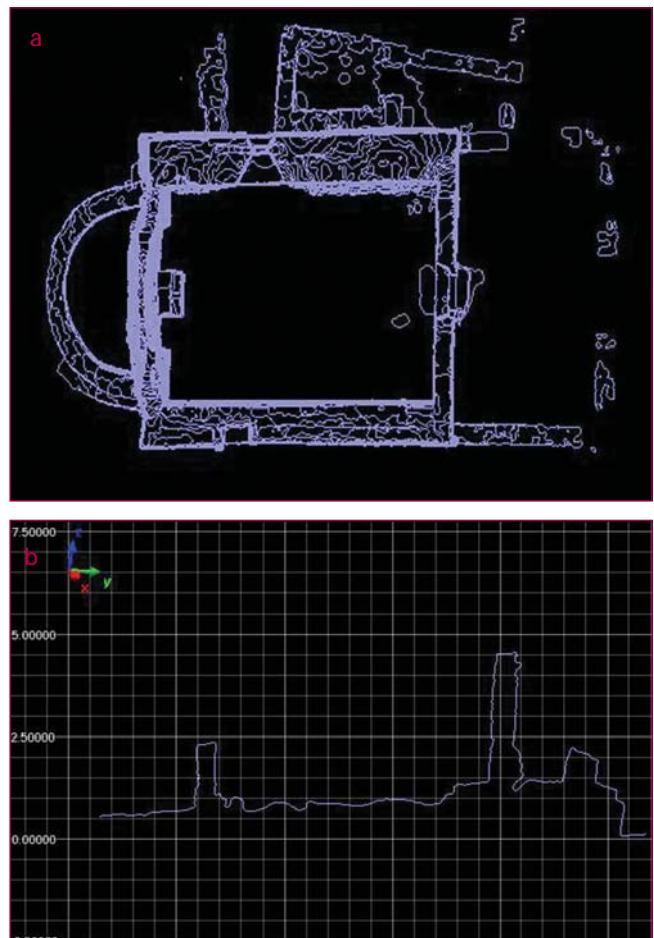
Sezioni e profili ricavati direttamente dal modello 3D: a sinistra pianta dell'oratorio medievale (a) e a destra sezione Est-Ovest dell'edificio (b).
